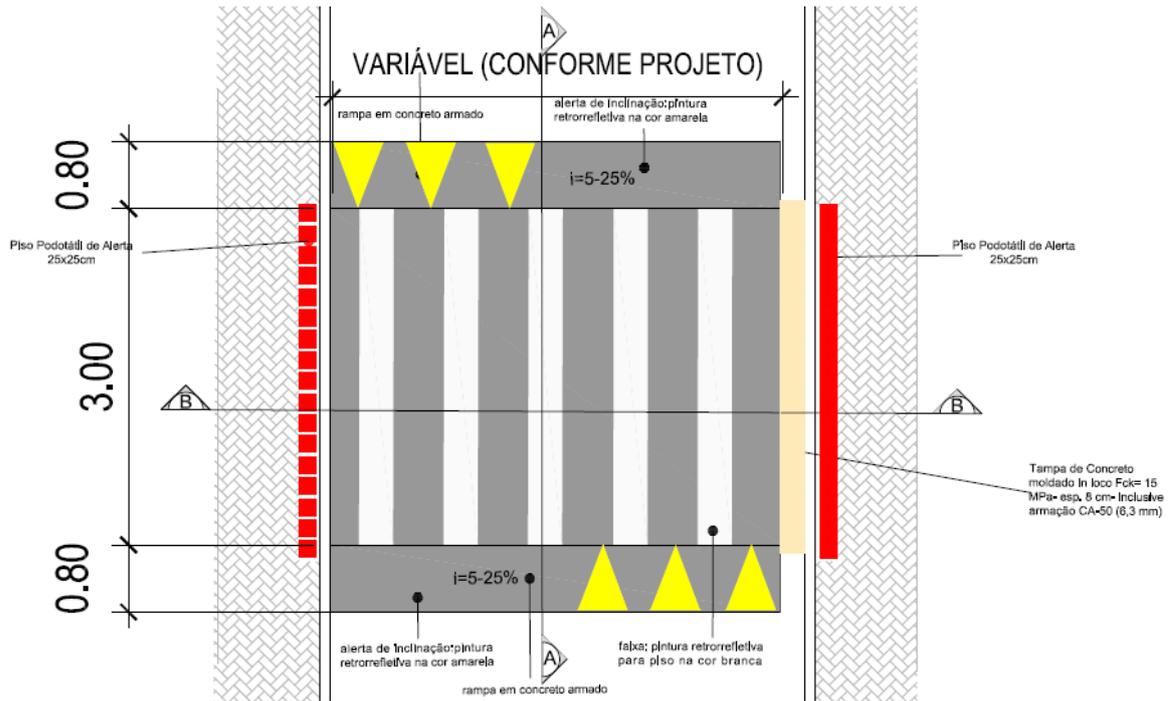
Detalhe construtivo em planta acabada da faixa elevada
